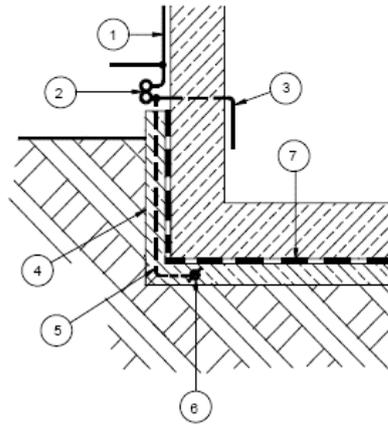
Fundación aislada con electrodo de puesta a tierra de fundación con capa de concreto no reforzado bajo una capa de aislamiento bituminoso
